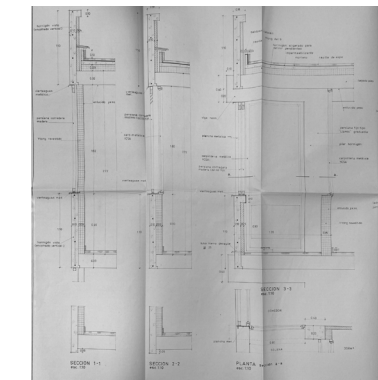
Plano de secciones constructivas donde se materializa el proyecto.
